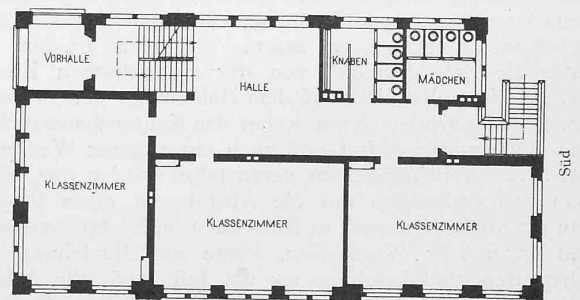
Grundriss vom Erdgeschoss. — Masstab 1 : 400.
